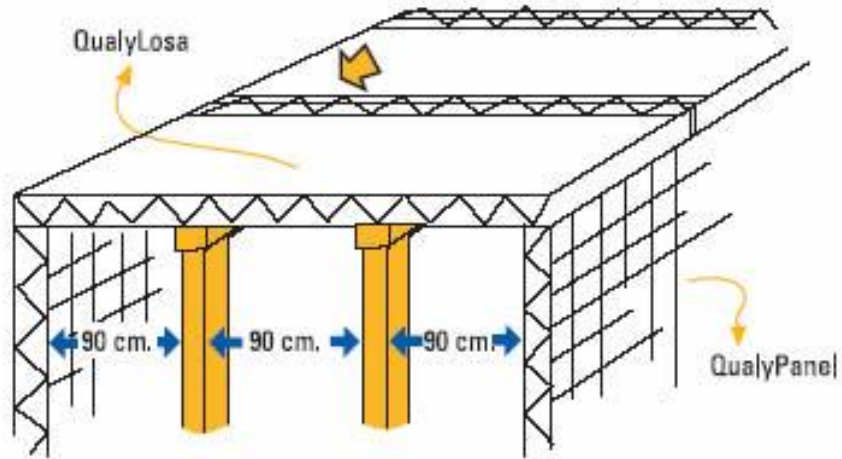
Apuntalamiento de panel Covintec para losas.
